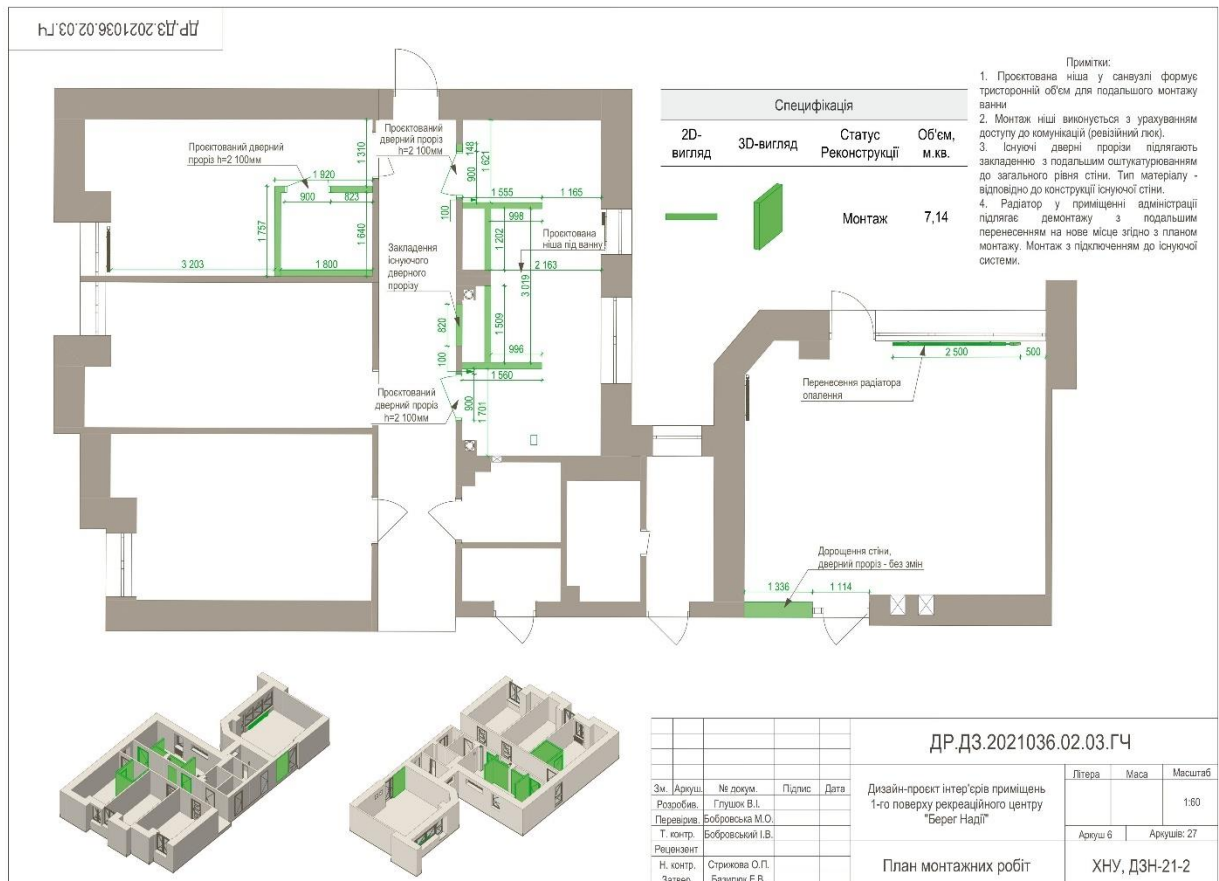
План монтажних робіт кімнат першого поверху
